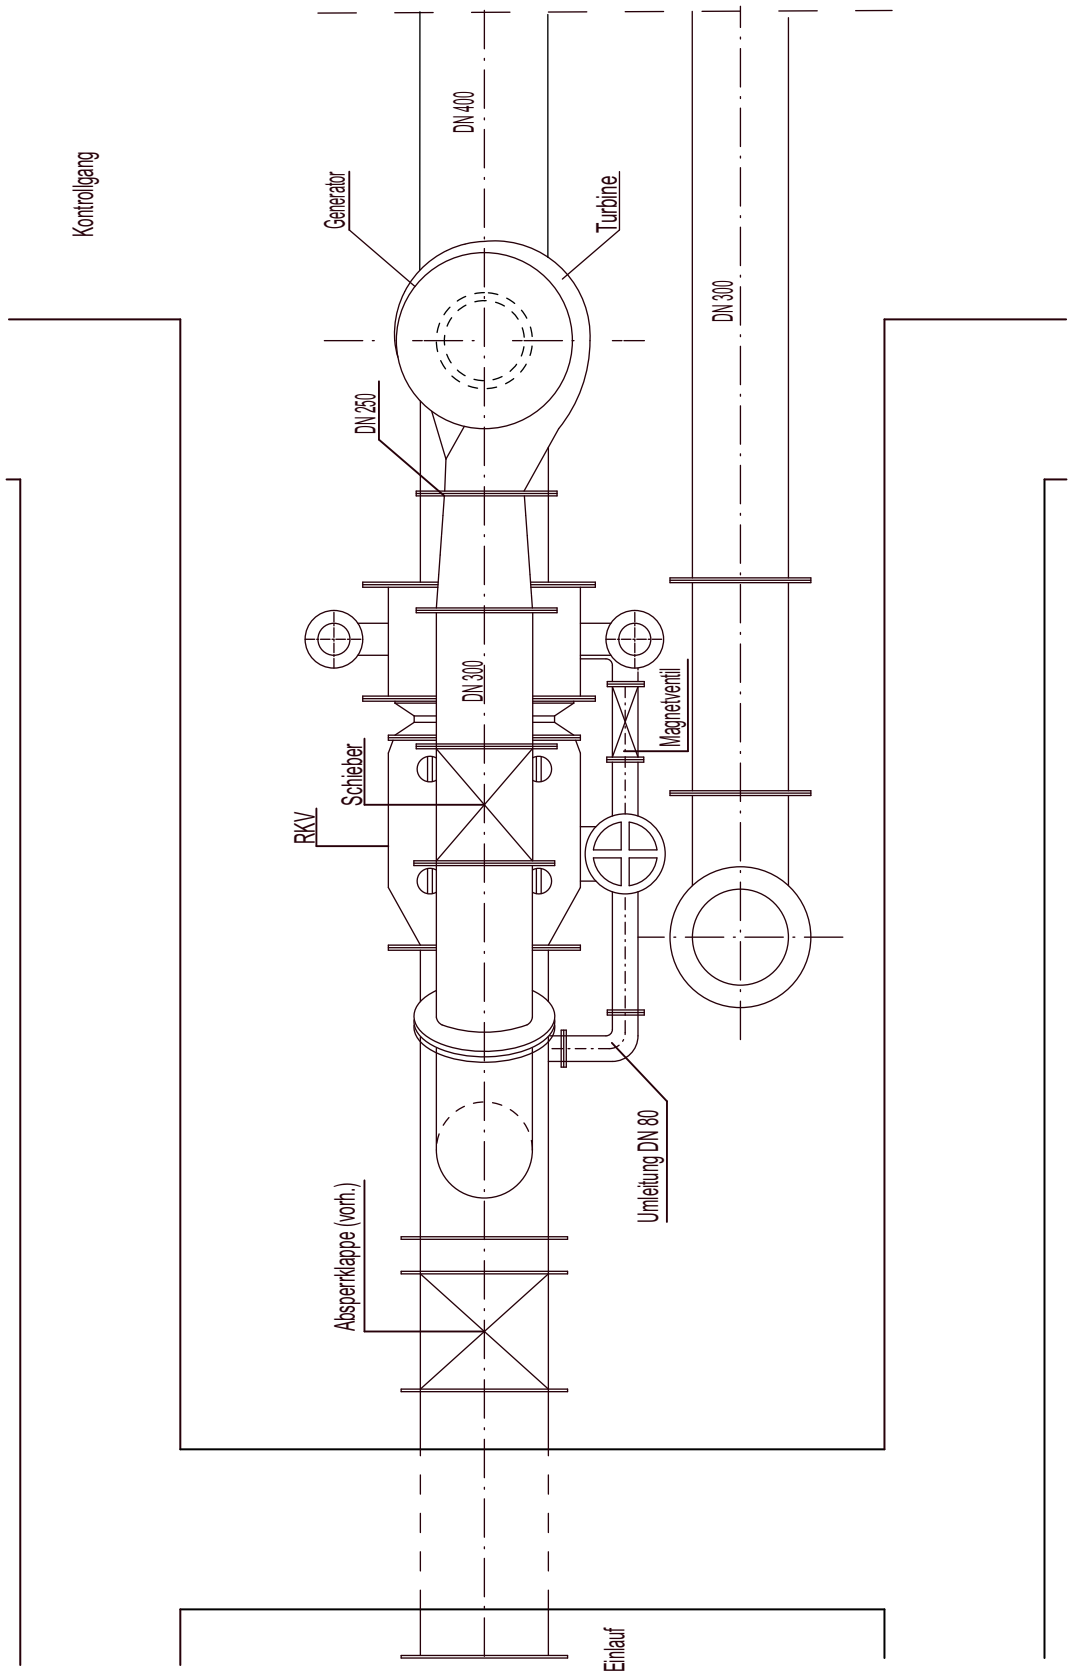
Vorzugsvariante / Variante III: Grundriss M.: 1:25
